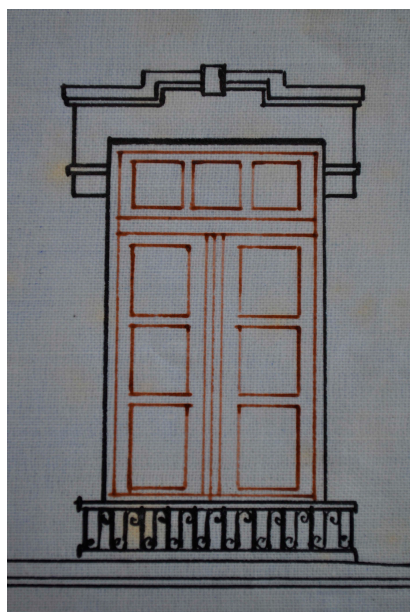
Remate de jambas. Unid.Instal 610-4. Archivo La Laguna. Arqto. Javier Felíp. Foto: el autor.
